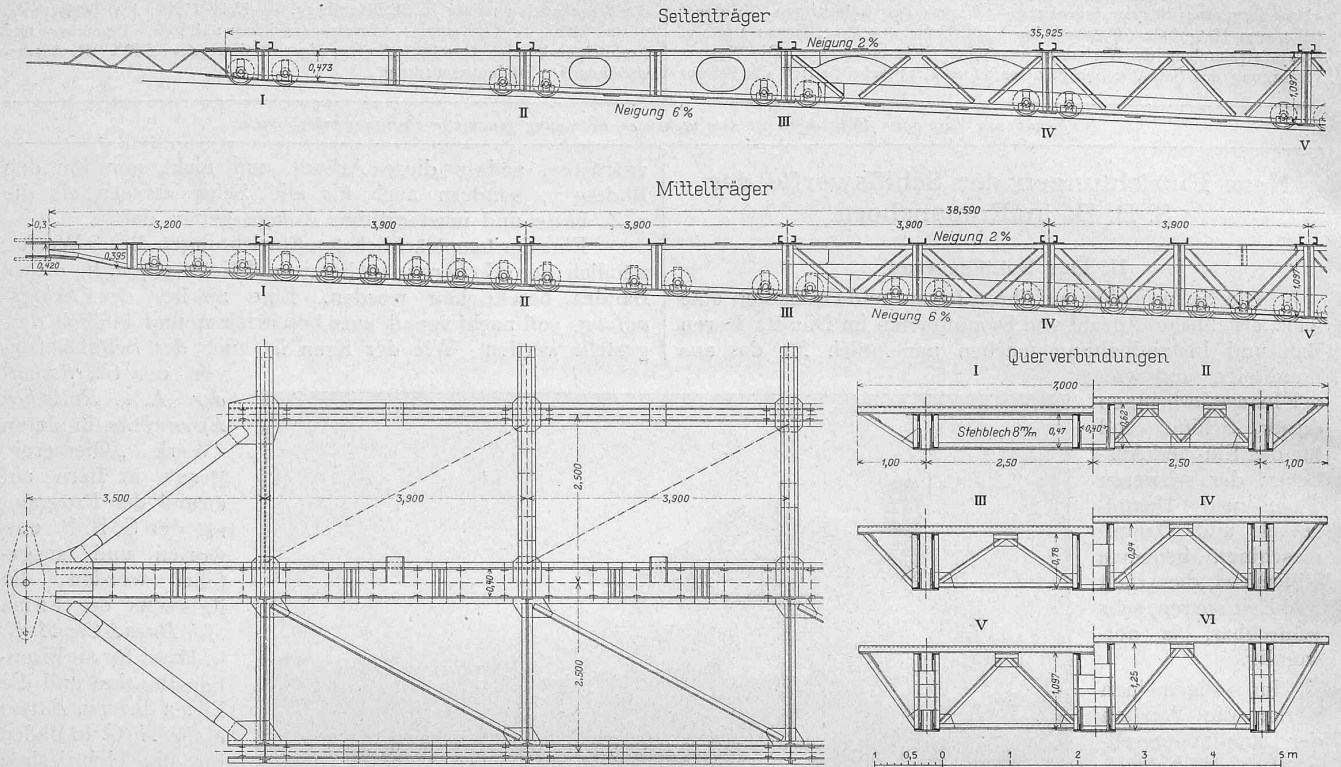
Oberer Teil des Aufzugwagens, Ansichten, Draufsicht und Querschnitte. — Masstab 1:100.
